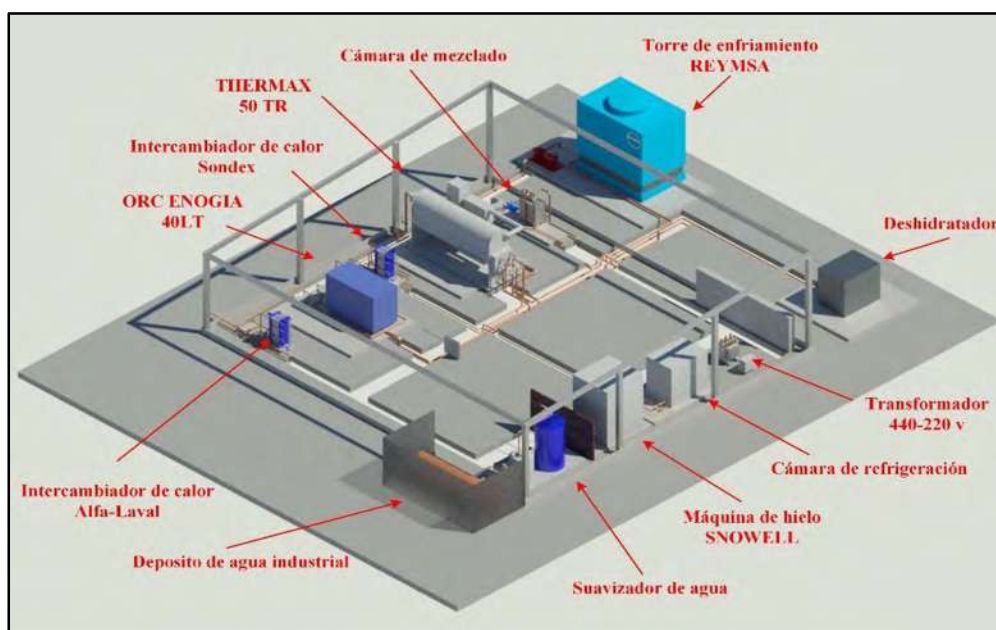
Distribución de equipos principales y subsistemas de la planta.
